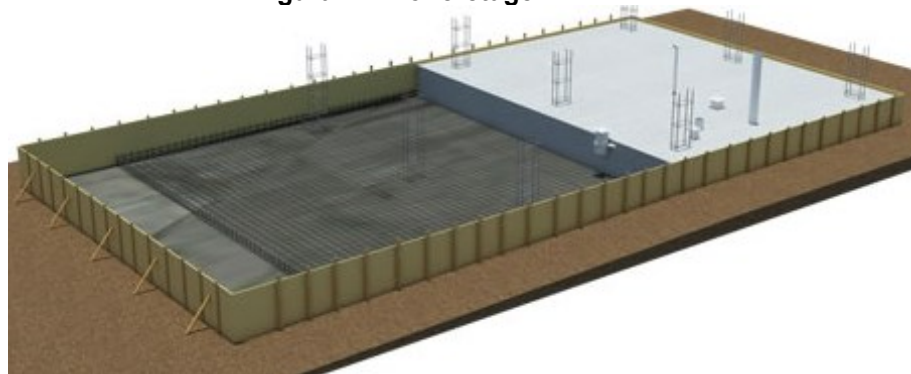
Formas, manta impermeabilizante, armadura e tubulações
